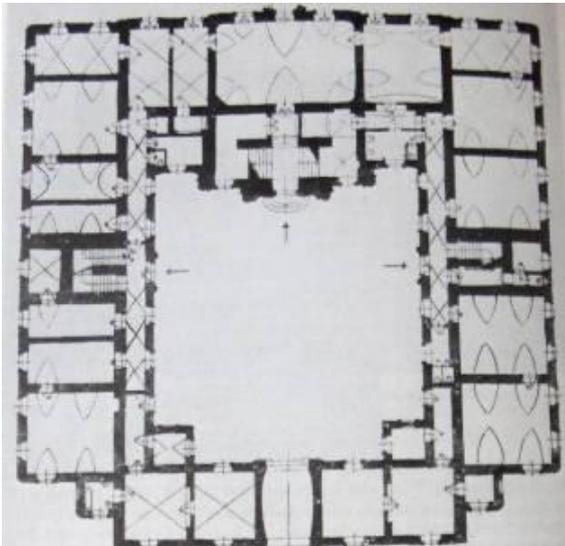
Schloss Esterházy in Cseklész, Grundriss, Erdgeschoss (links)
